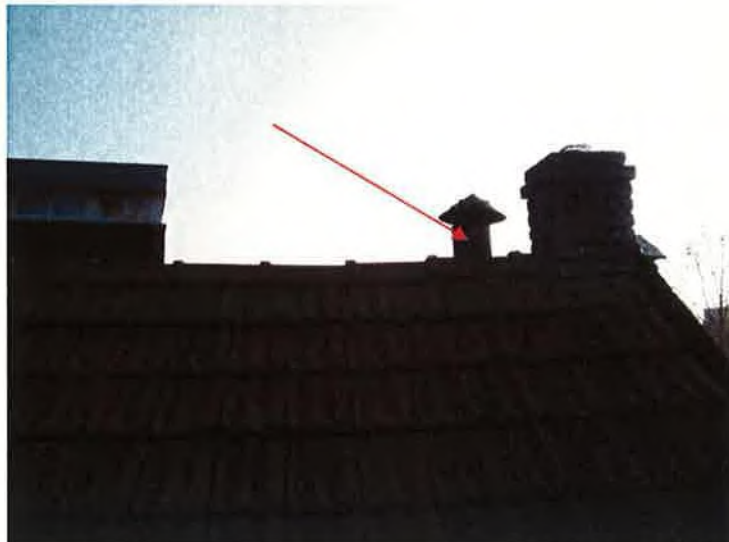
asbesthoudende pijp op het dak van Laurentiusstraat 88.
